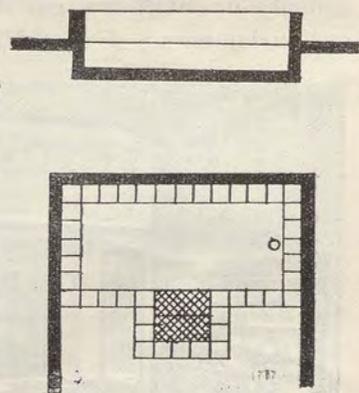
Sezione e pianta di una vasca massiva per metà nel pavimento.
